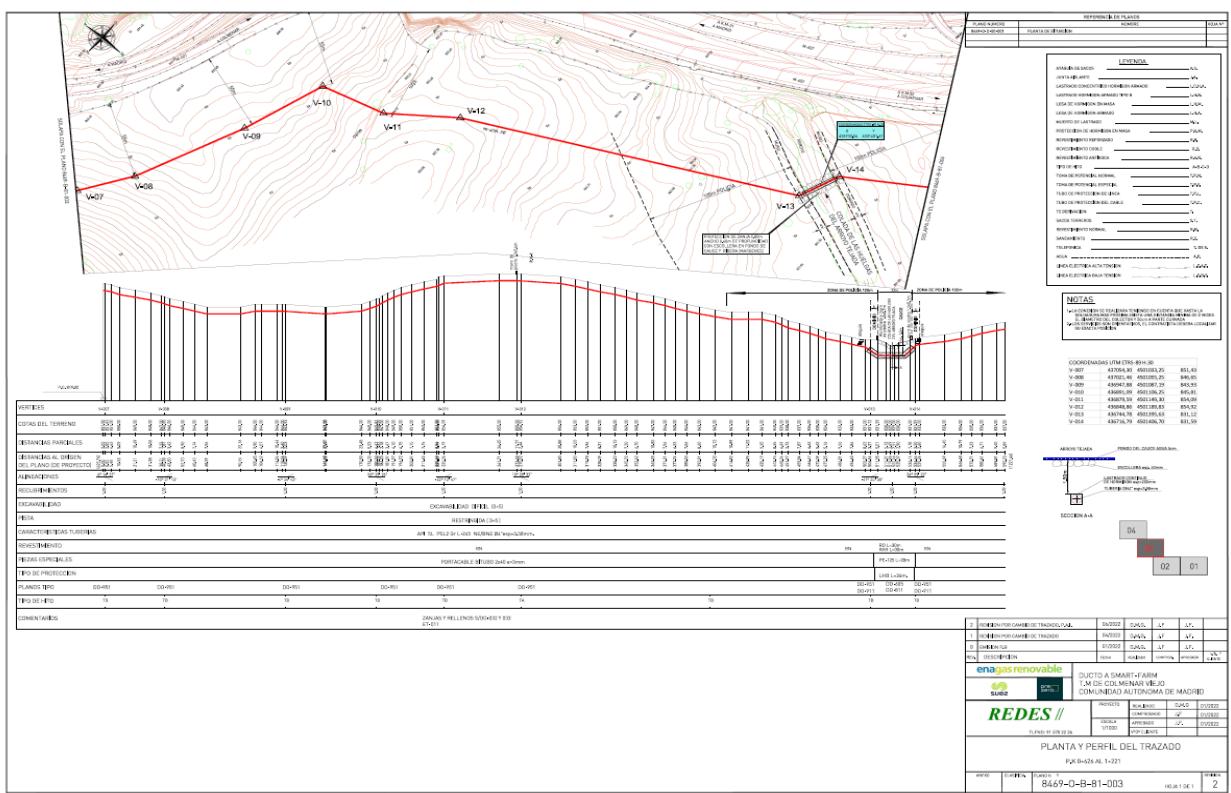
Plano de situación. En rojo el Ducto de evacuación.
